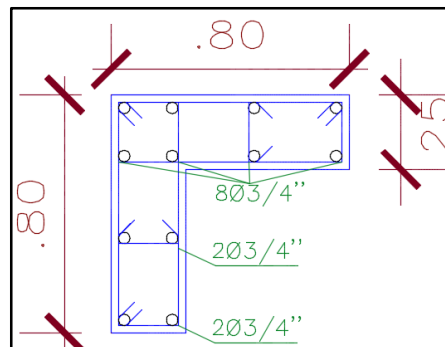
Detallado de acero de la columna "B3" - Sistema dual tipo I
